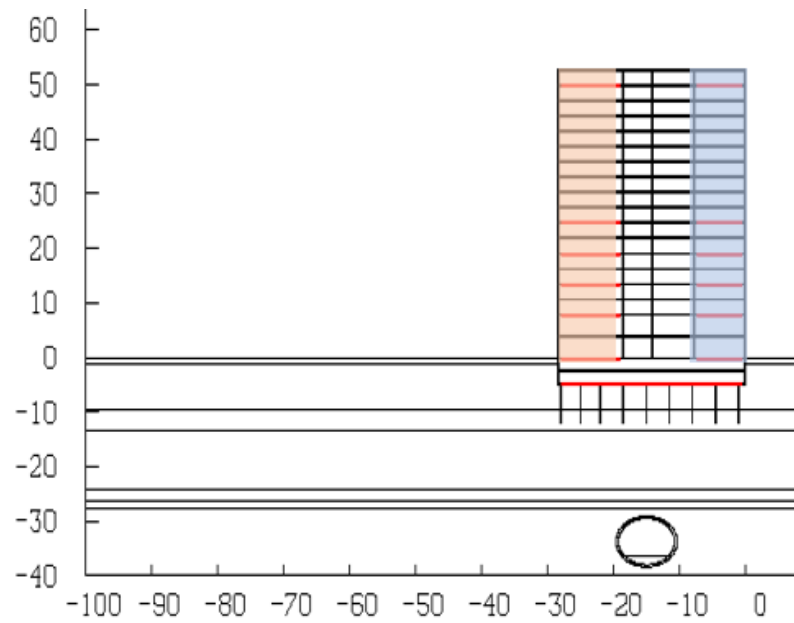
Bâtiment de Droite : 9 murs de 10 cm pour 28,4 m (taux : 3.17 %)
